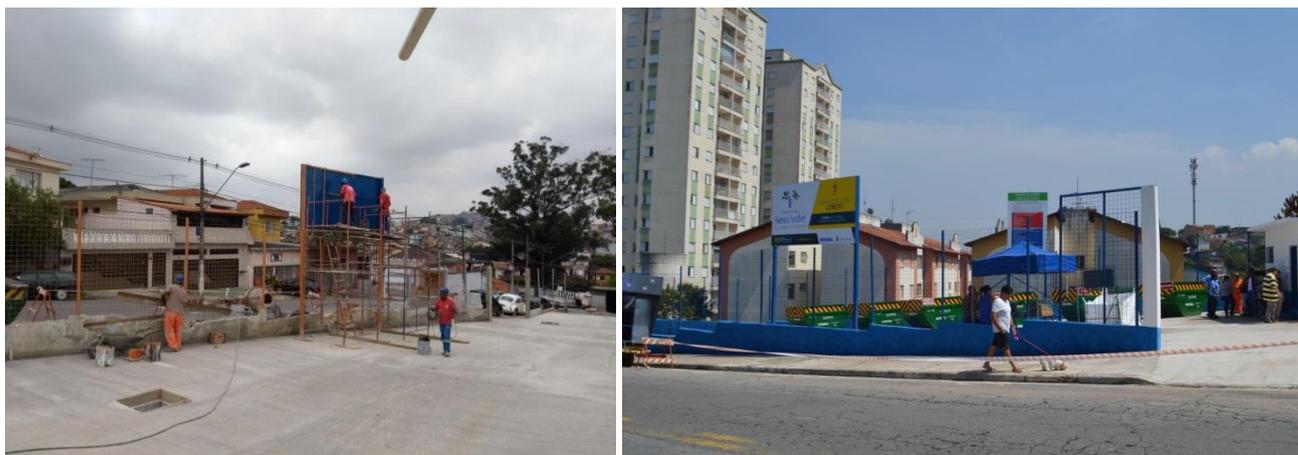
EC Loreto em construção e; Foto 2 – EC finalizada.
